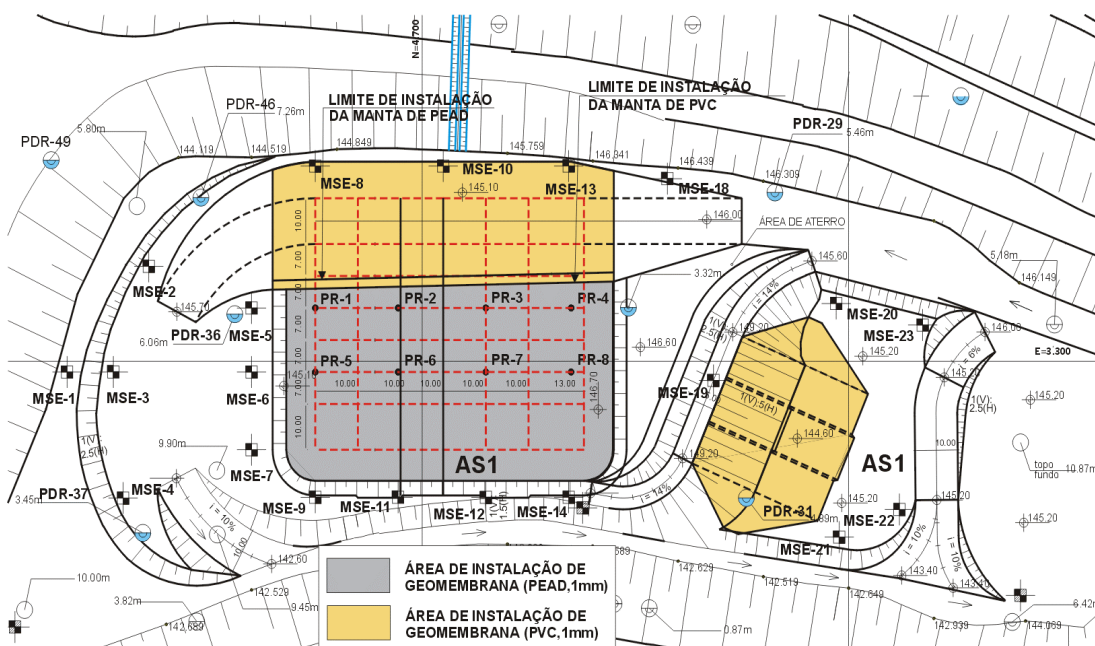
Aterro experimental – Tratamento e impermeabilização da fundação.
